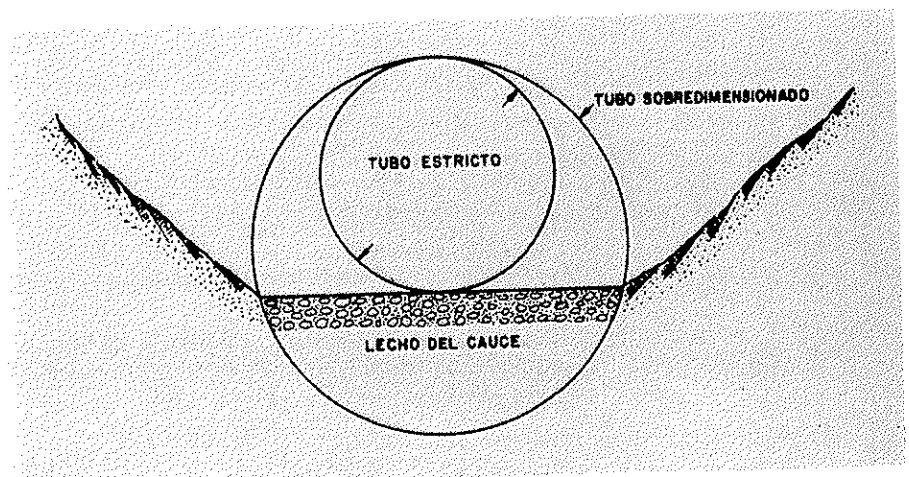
TUBO SOBREDIMENSIONADO Y ENTERRADO PARA RESPETAR LA ANCHURA DEL CAUCE
